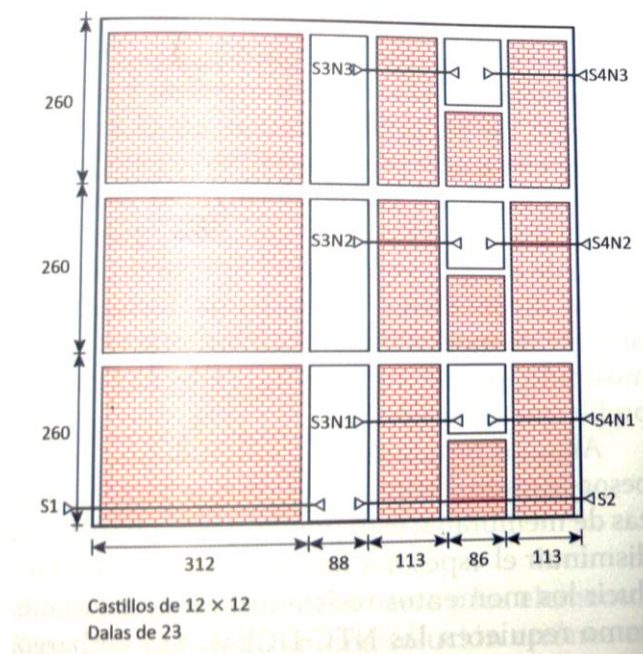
Modelo de prueba (Sociedad Mexicana de Ingeniería Estructural, 2019)
